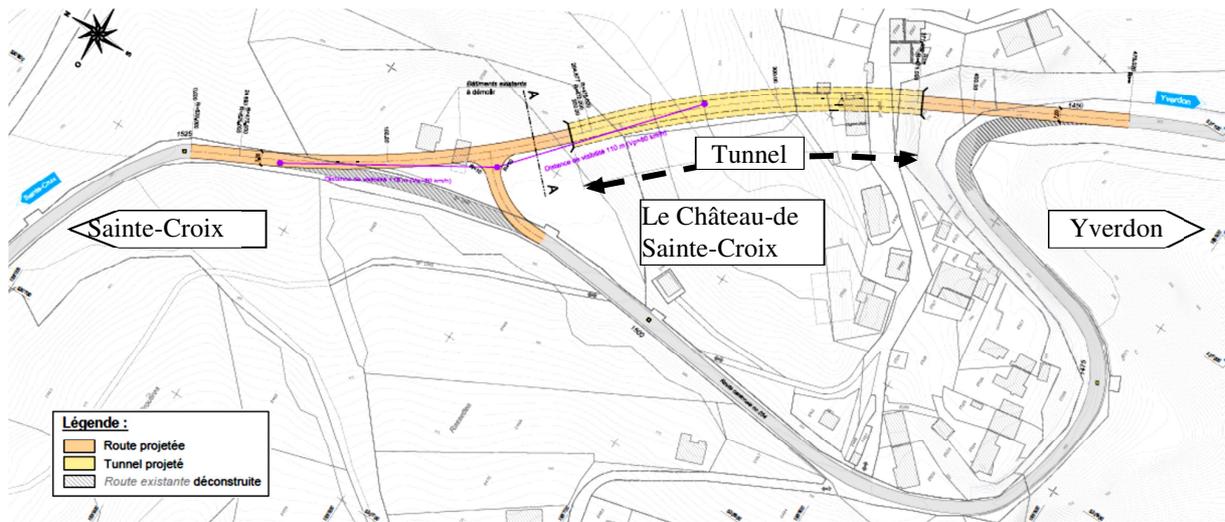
Situation du tunnel passant sous Le Château-de-Sainte-Croix
